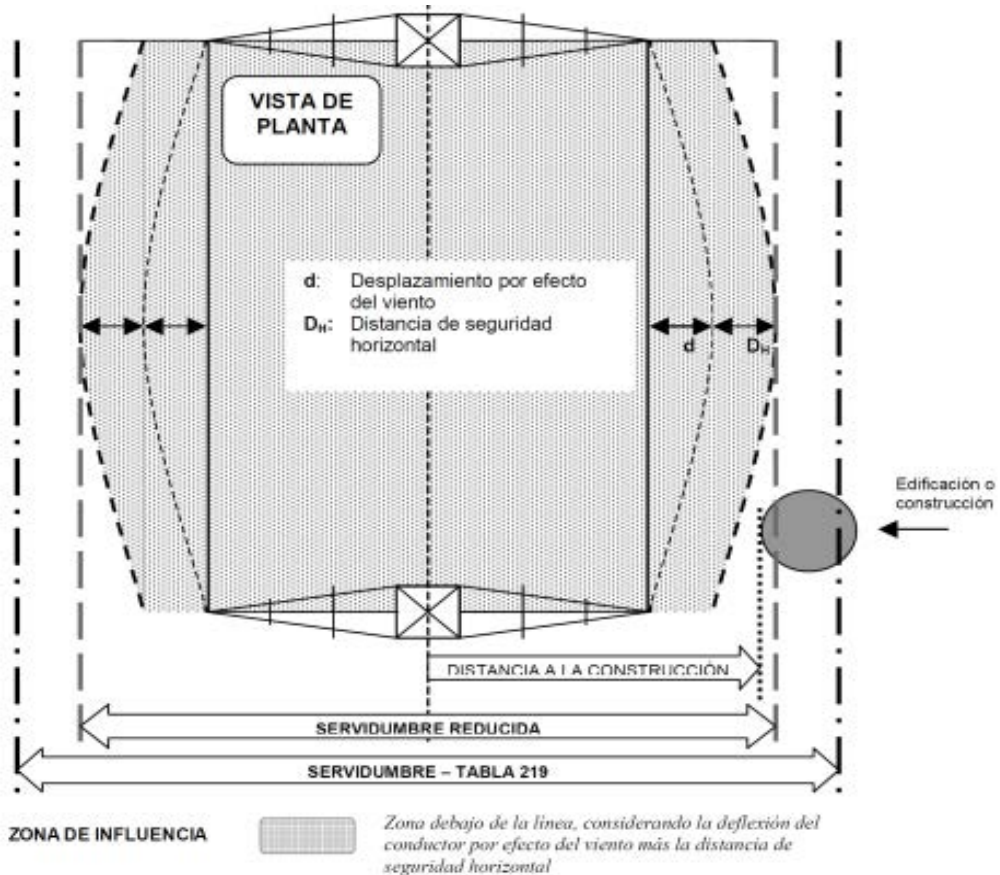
Vista de Planta para la determinación de la faja de servidumbre
